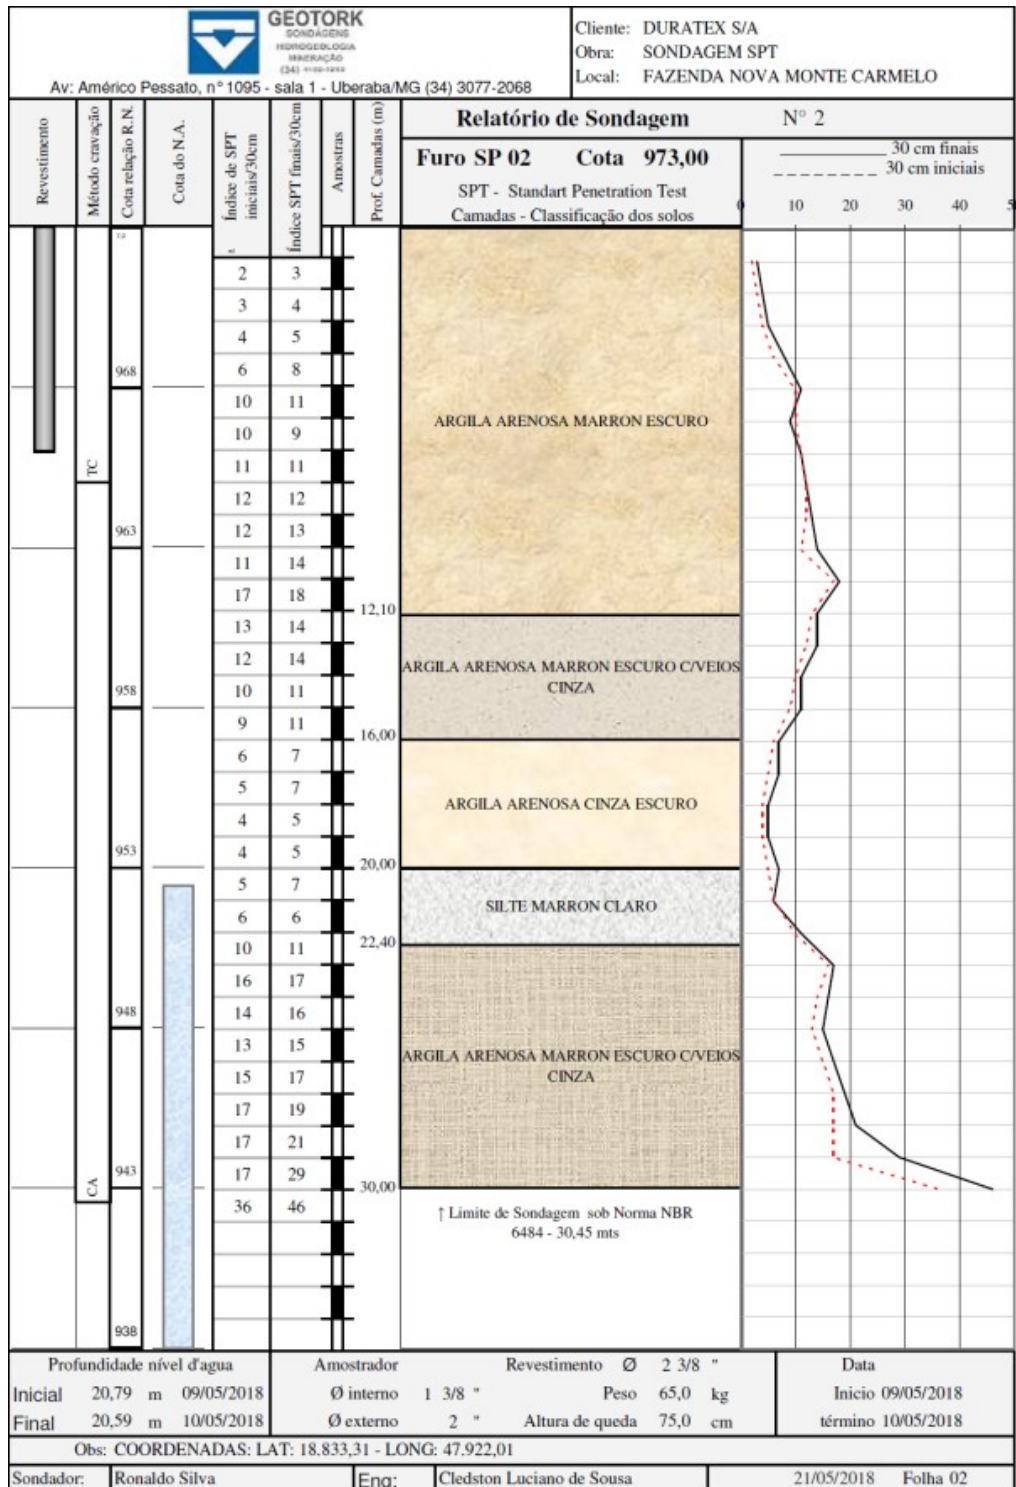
Perfil do furo de sondagem SP02. Fonte: GEOTORK, 2018.
